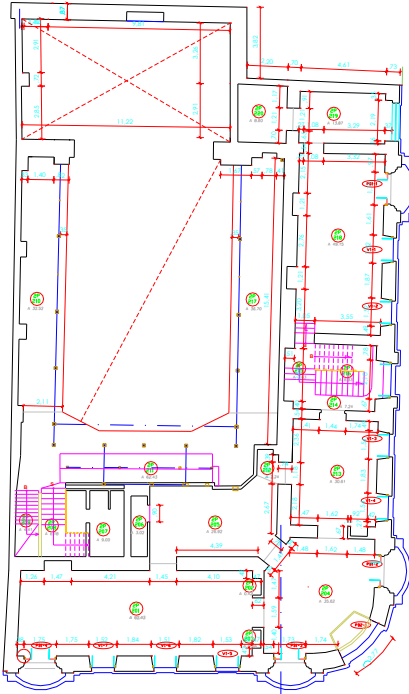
Levantamiento arquitectónico segundo piso alto – segundo palco
